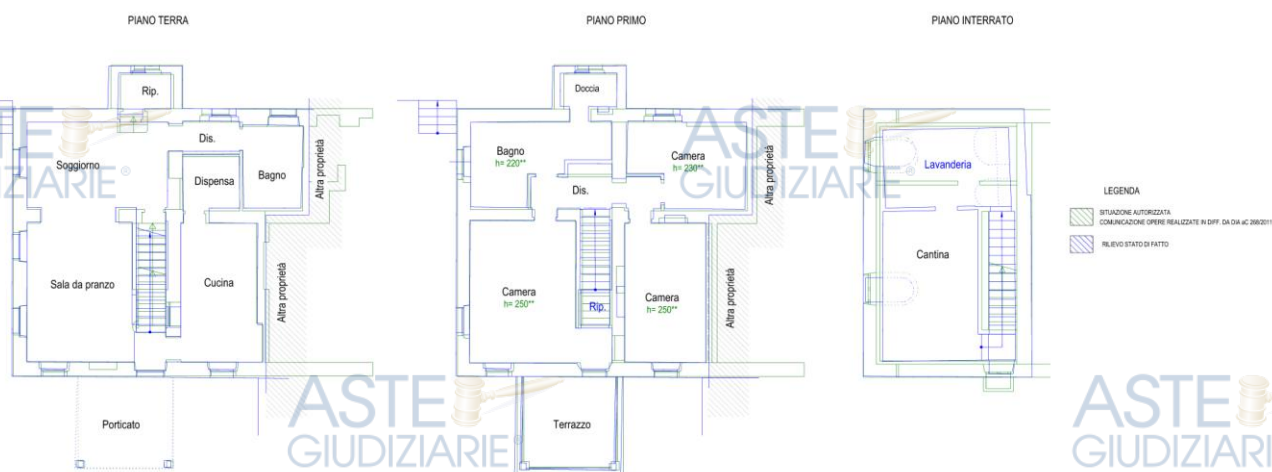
Confronto fra la situazione autorizzata e lo stato di fatto
